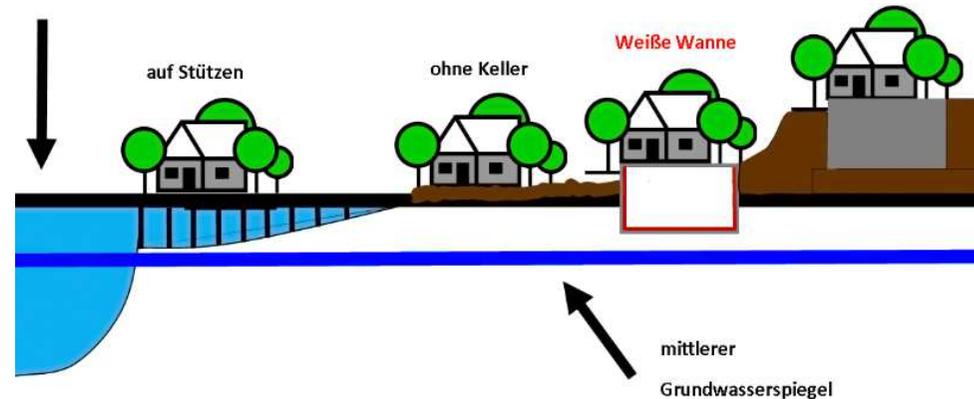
Wasserundurchlässige Bauwerke (Weiße Wannen) aus Beton ohne zusätzliche Abdichtung in verschiedenen Bauweisen.
